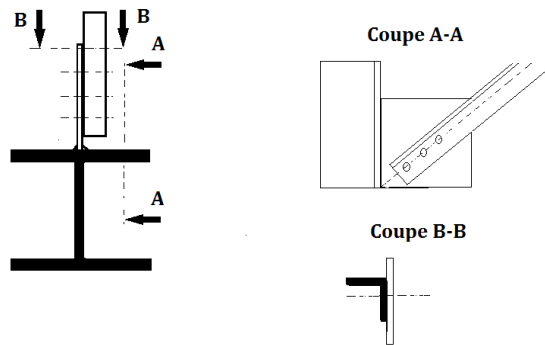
Assemblage de contreventement dans la semelle du poteau.
